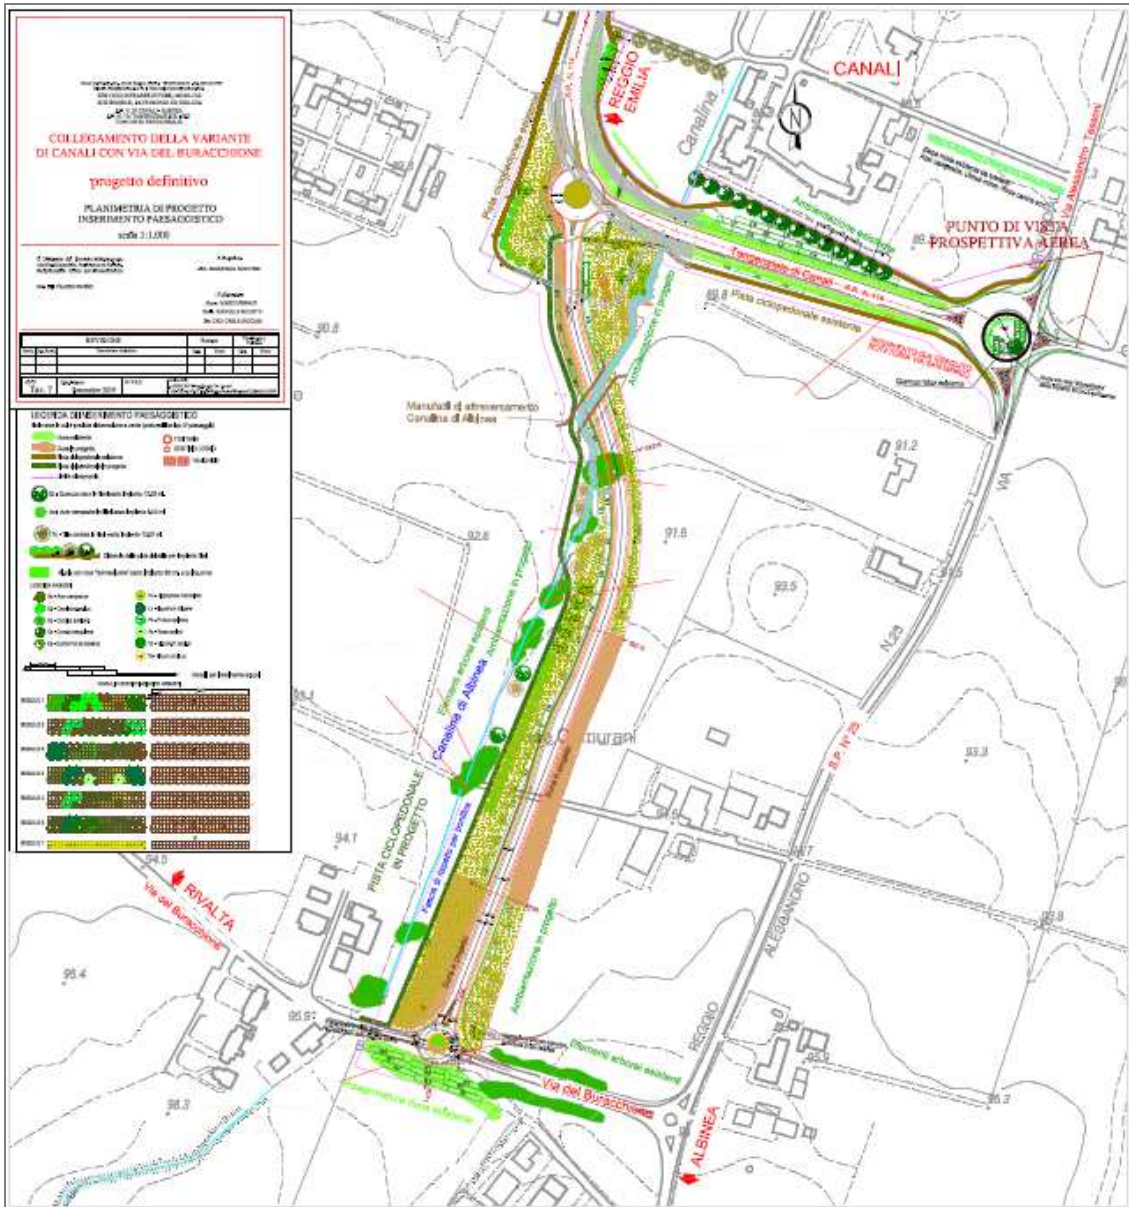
Planimetria di Progetto – Inserimento paesaggistico
